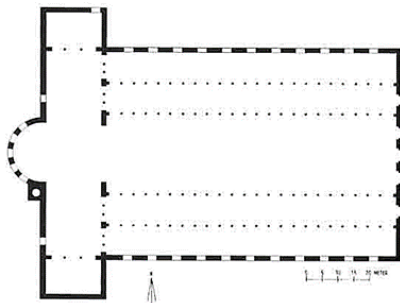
Abb.IV: Grundriss ohne Chor => T-förmiger Grundriss bei frühchristlichen Basiliken.
